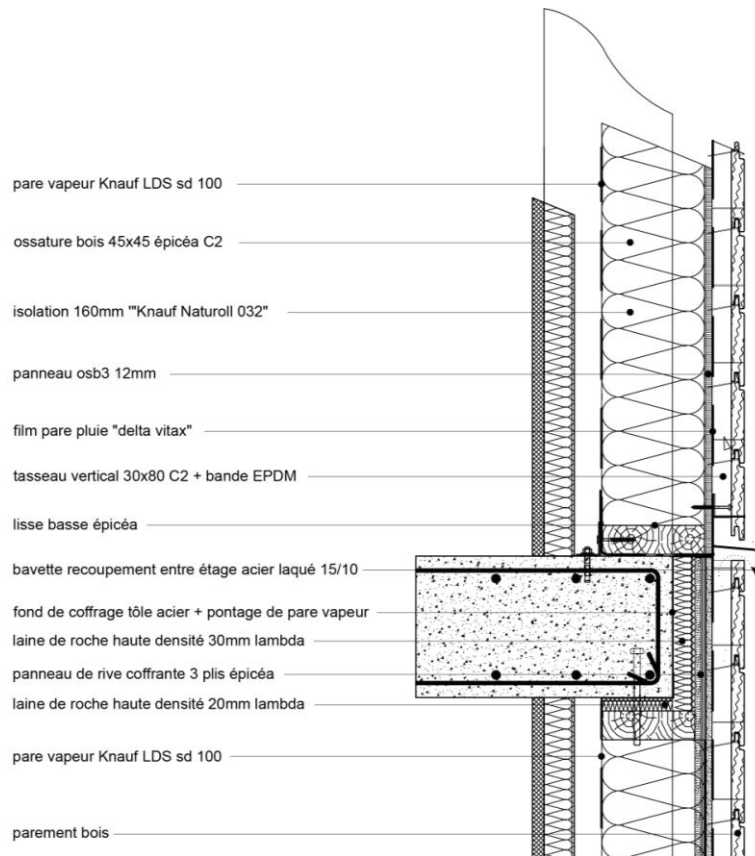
Coupe sur plancher intermédiaire (extrait carnet de détail EXE Satob)
